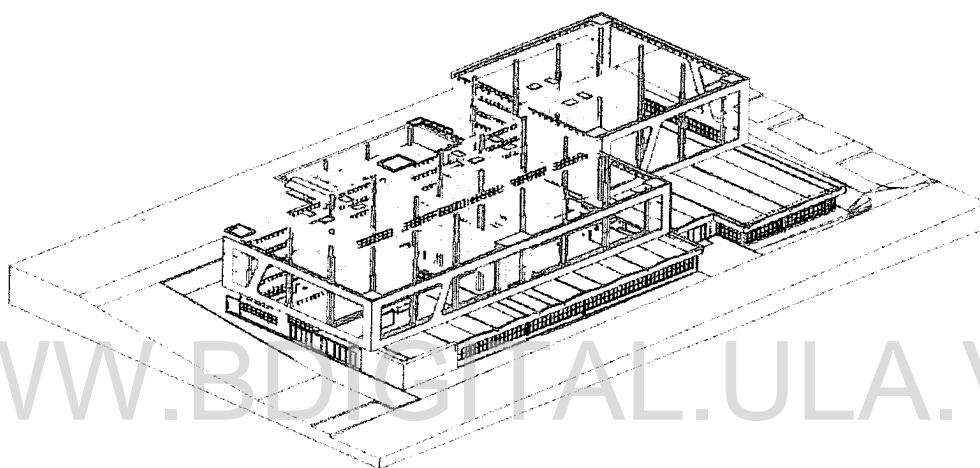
, Diseño arquitectónico en Autocad 3D.
